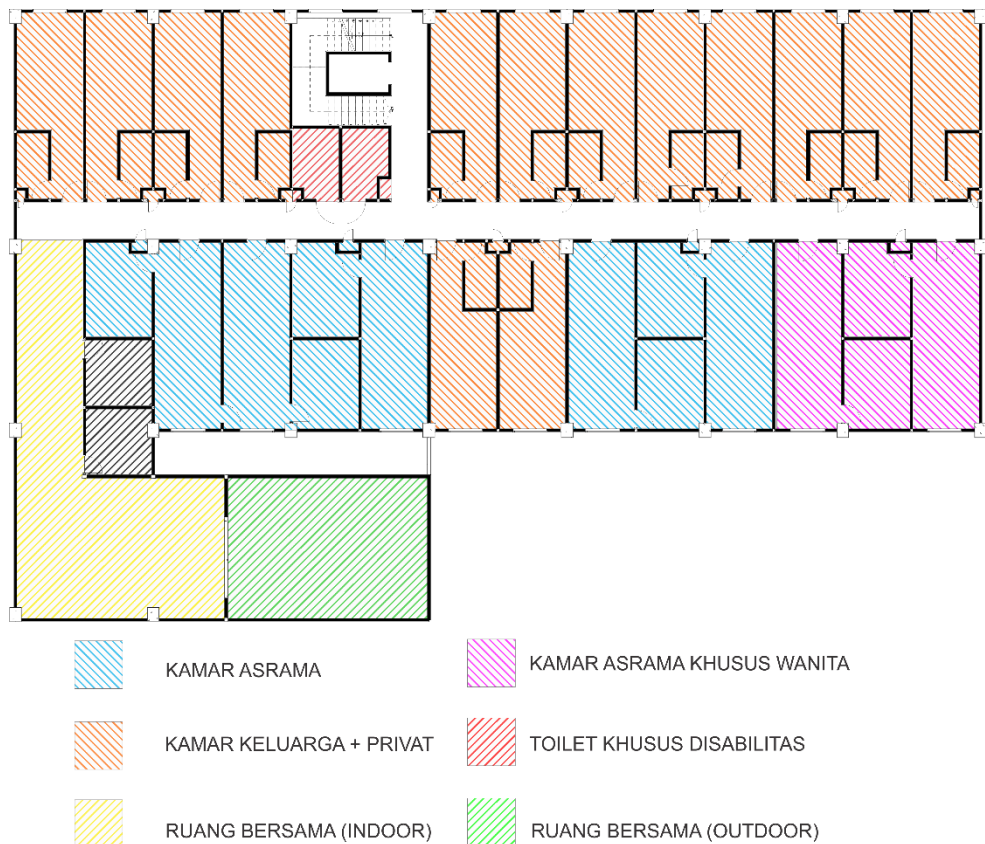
Skema Pembagian Ruang Pada Lantai 1
